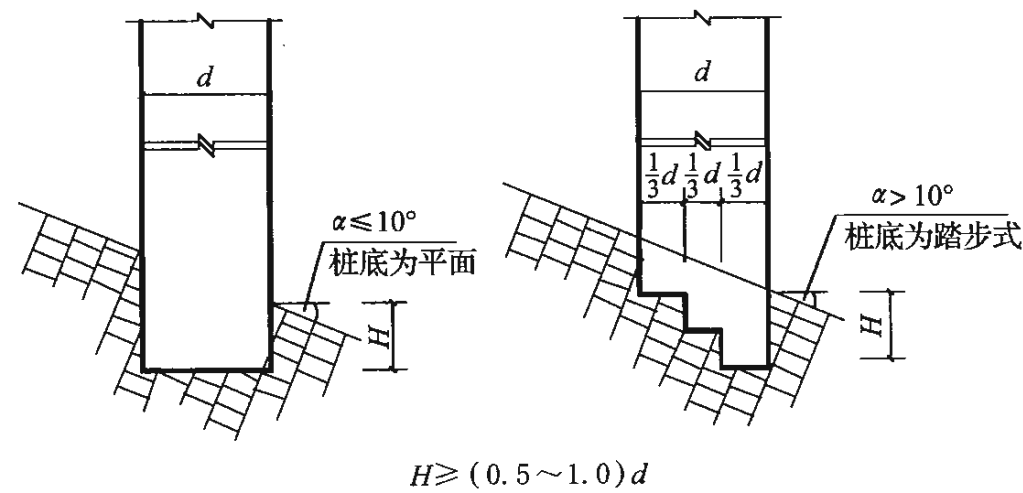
基岩顶面为斜面时桩端做法示意
